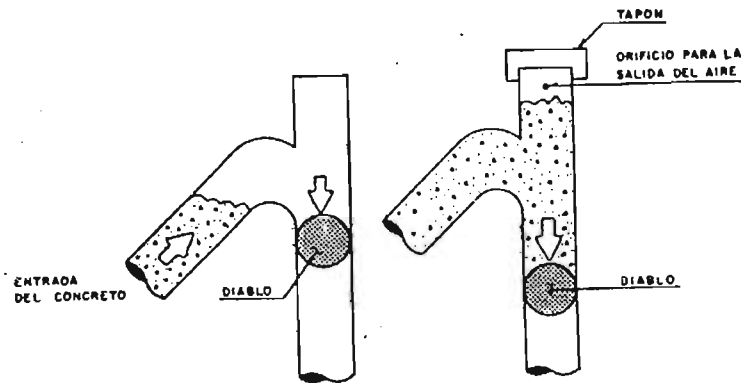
Dispositivo para la colocación del tapón deslizante para colados por bombeo de concreto
